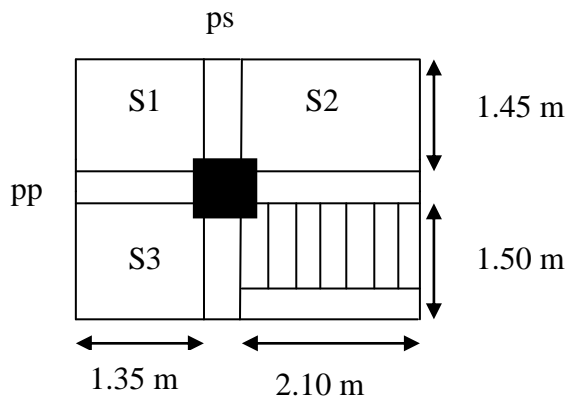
Surface afférente du poteau 3 (absence de l'escalier duplex)
